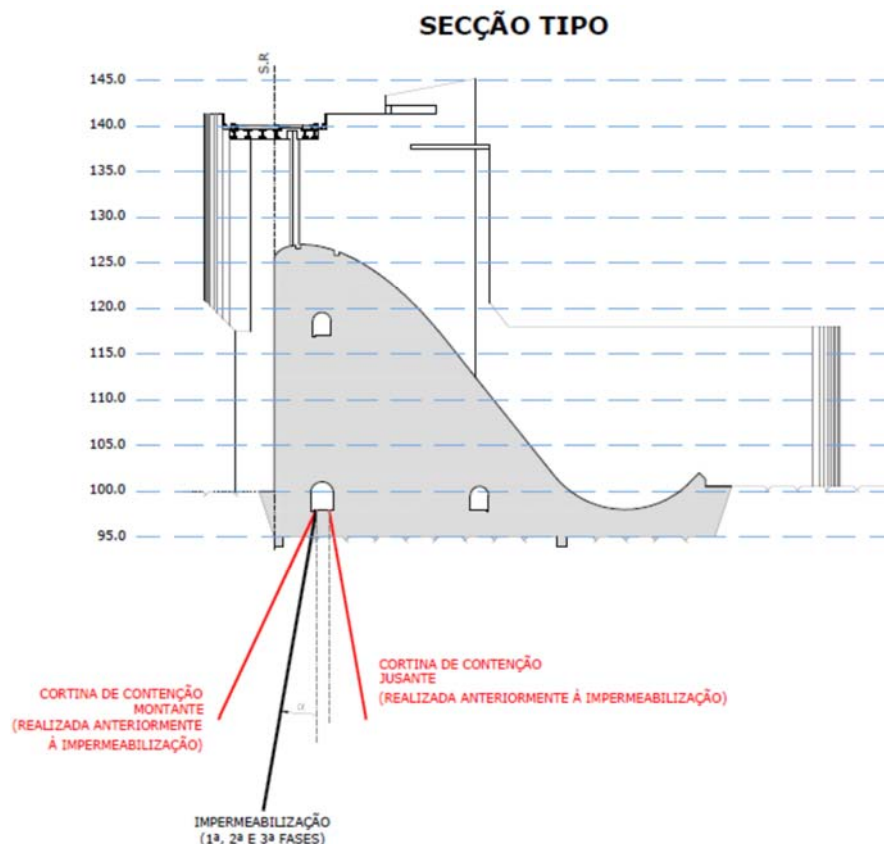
Secção tipo do tratamento de fundação do Escalão Jusante (AHBS). (adaptado de (EDP, 2011))
